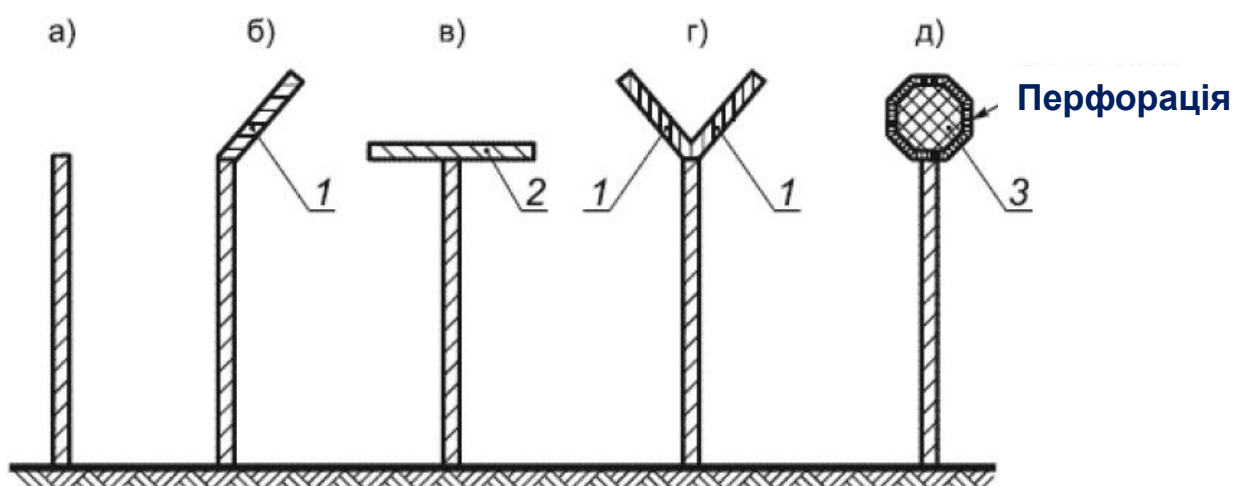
Форми верхнього козирка акустичного екрану
